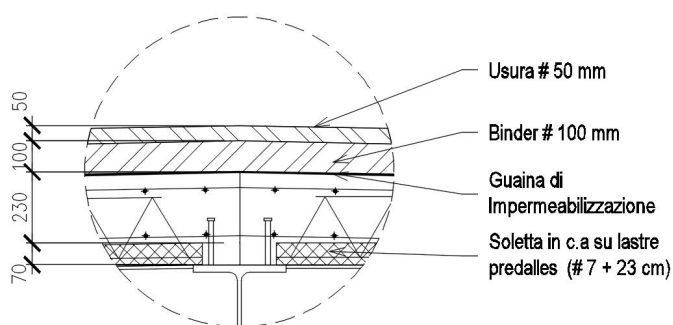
Dettaglio pacchetto soletta in lastre predalles
